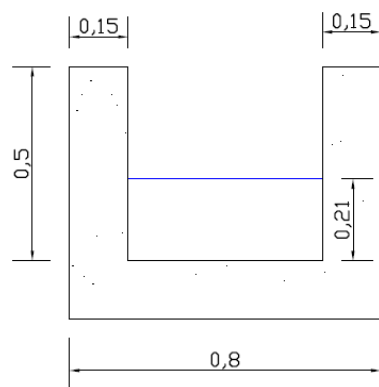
Dimensionamiento en metros del canal de aproximación.
